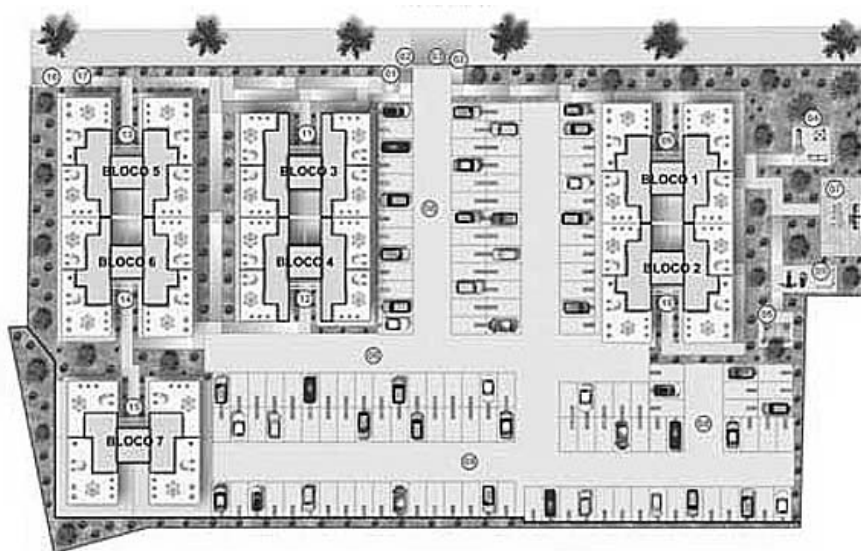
Residencial Parque Merindiva: Implantação.
